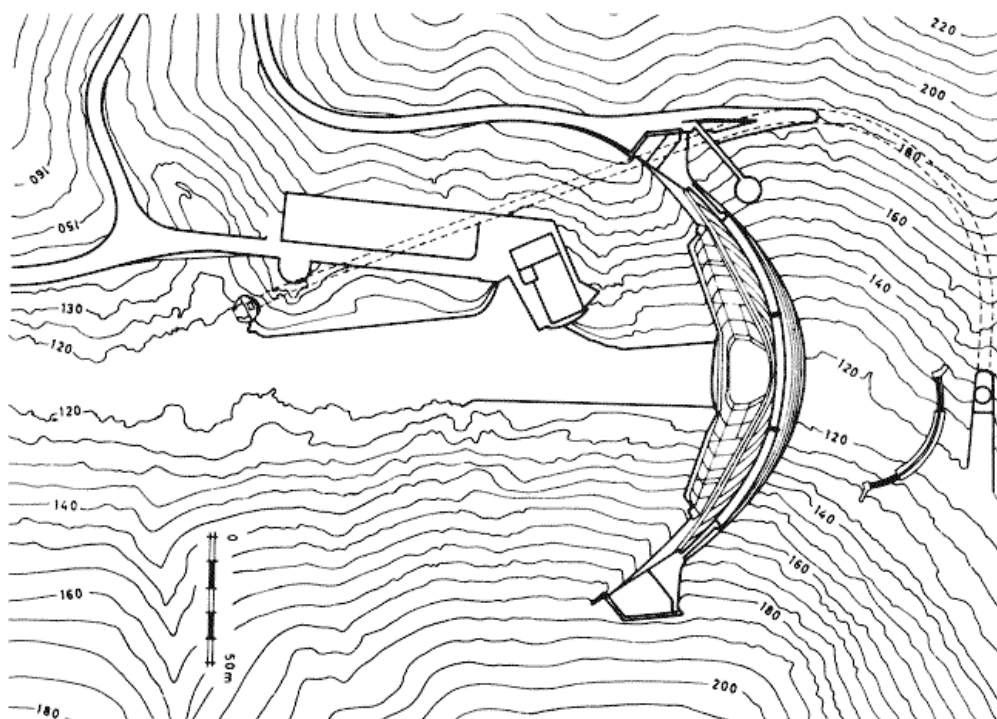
Barragem da Bouça. Planta (fonte: www.inag.pt)
